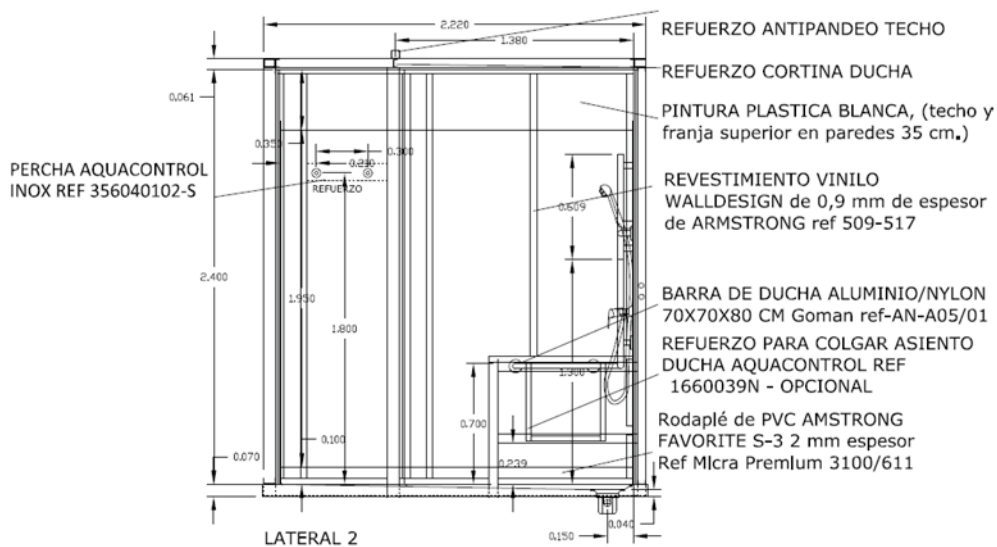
Plano alzado de baño prefabricado para hospital de Vigo, año 2013
